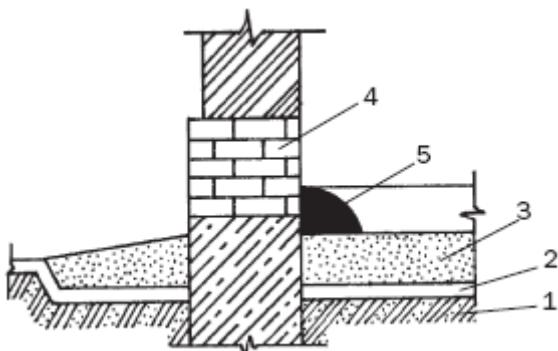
Устройство цоколя: 1 – грунт; 2 – песок; 3 – бетон; 4 – стена; 5 – стык
